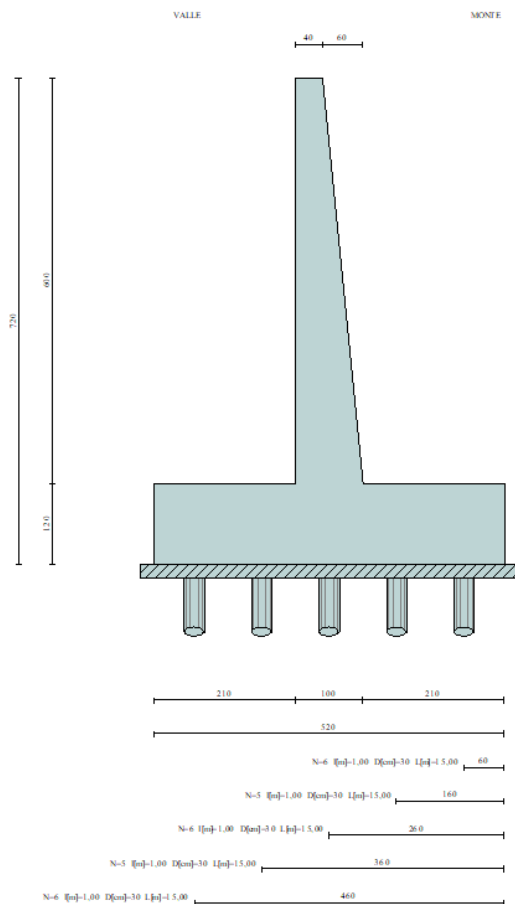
Muro Tipo E: geometria del muro di sostegno.
